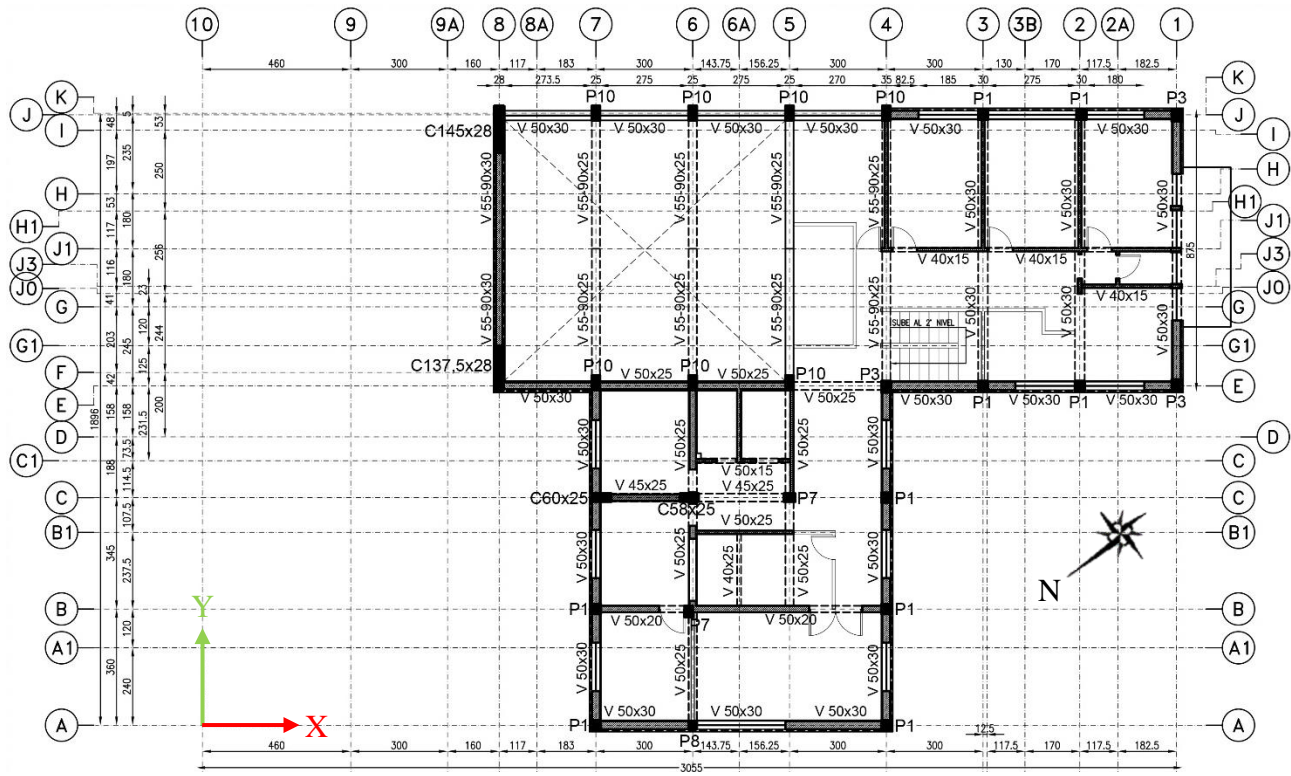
Planimetría del segundo nivel del edificio DIDECO.
